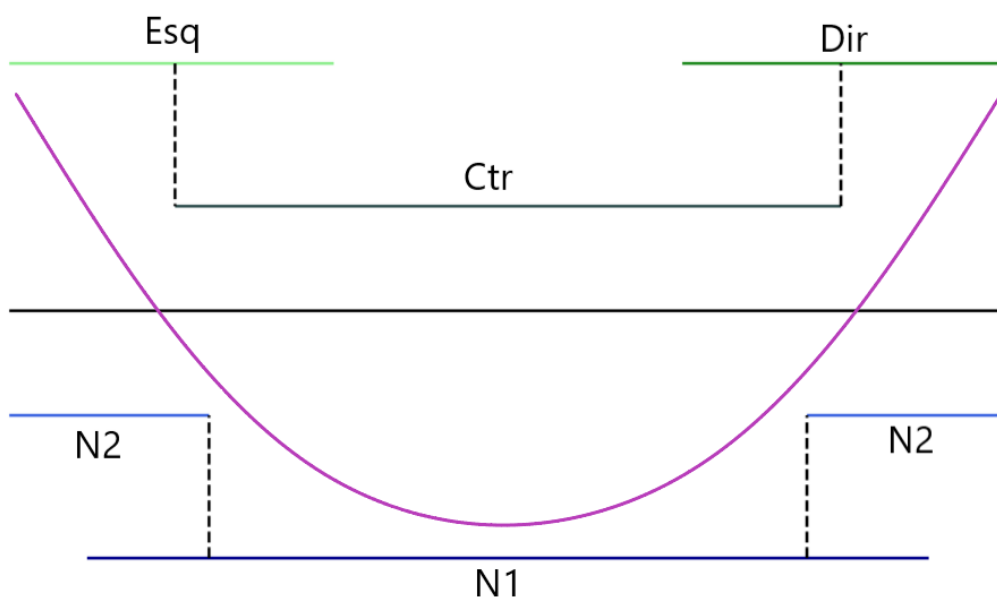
Imagem ilustrativa da disposição das armaduras longitudinais
